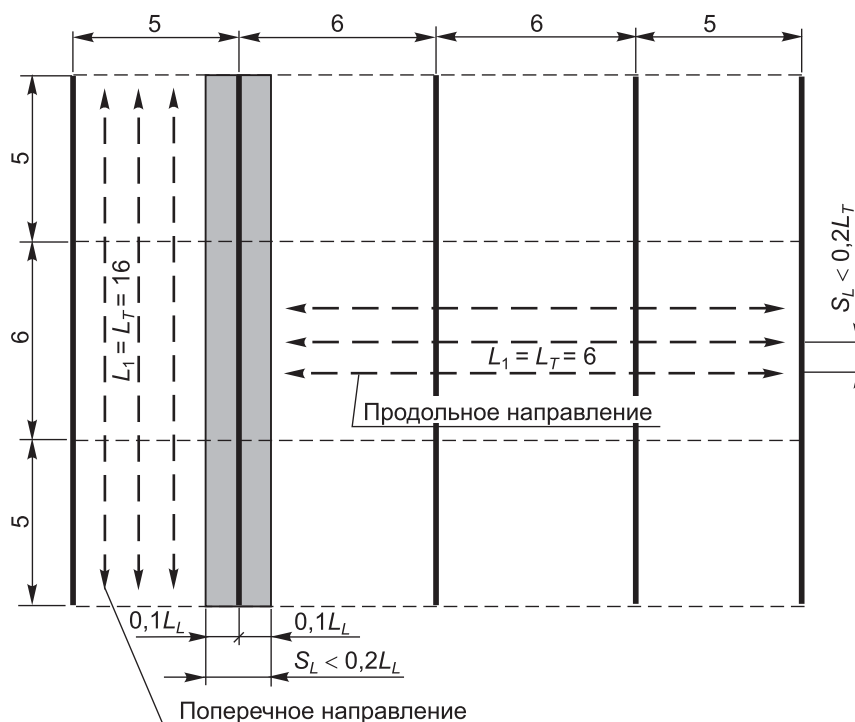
Схема для определения величины расчетных пролетов L_i при расчете связевых усилий для зданий с несущими стенами и плитами, работающими в одном направлении (при высоте этажа в свету $H \leq 3$ м)
